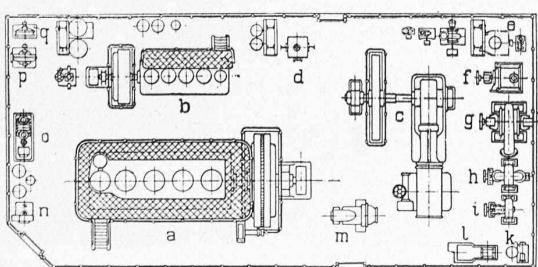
Ausstellung von Gebr. Sulzer, A.-G. — Grundriss 1:300.
